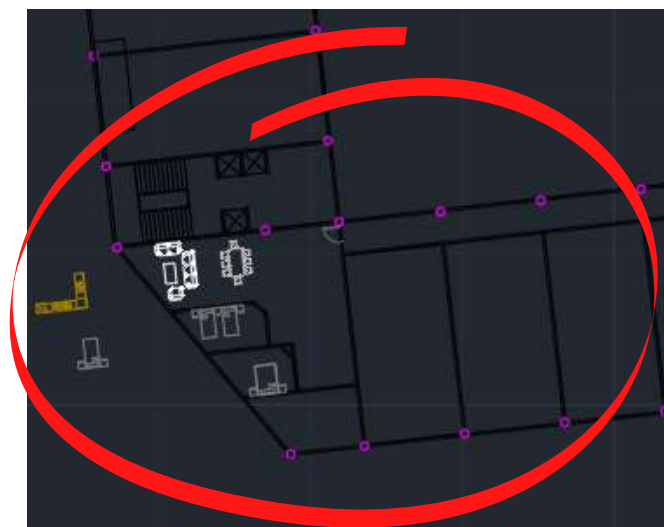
Propuestas de diseño. Fuente: Autoría propia.
